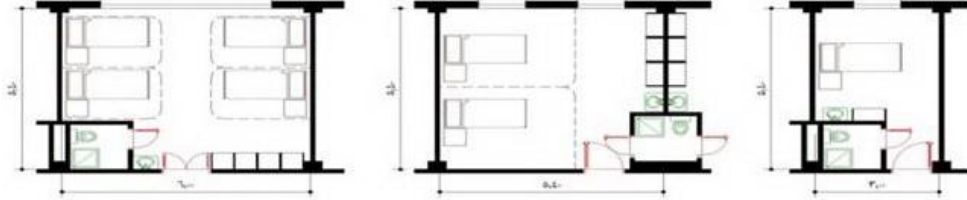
مسقط أفقي لغرفة مرضى.
